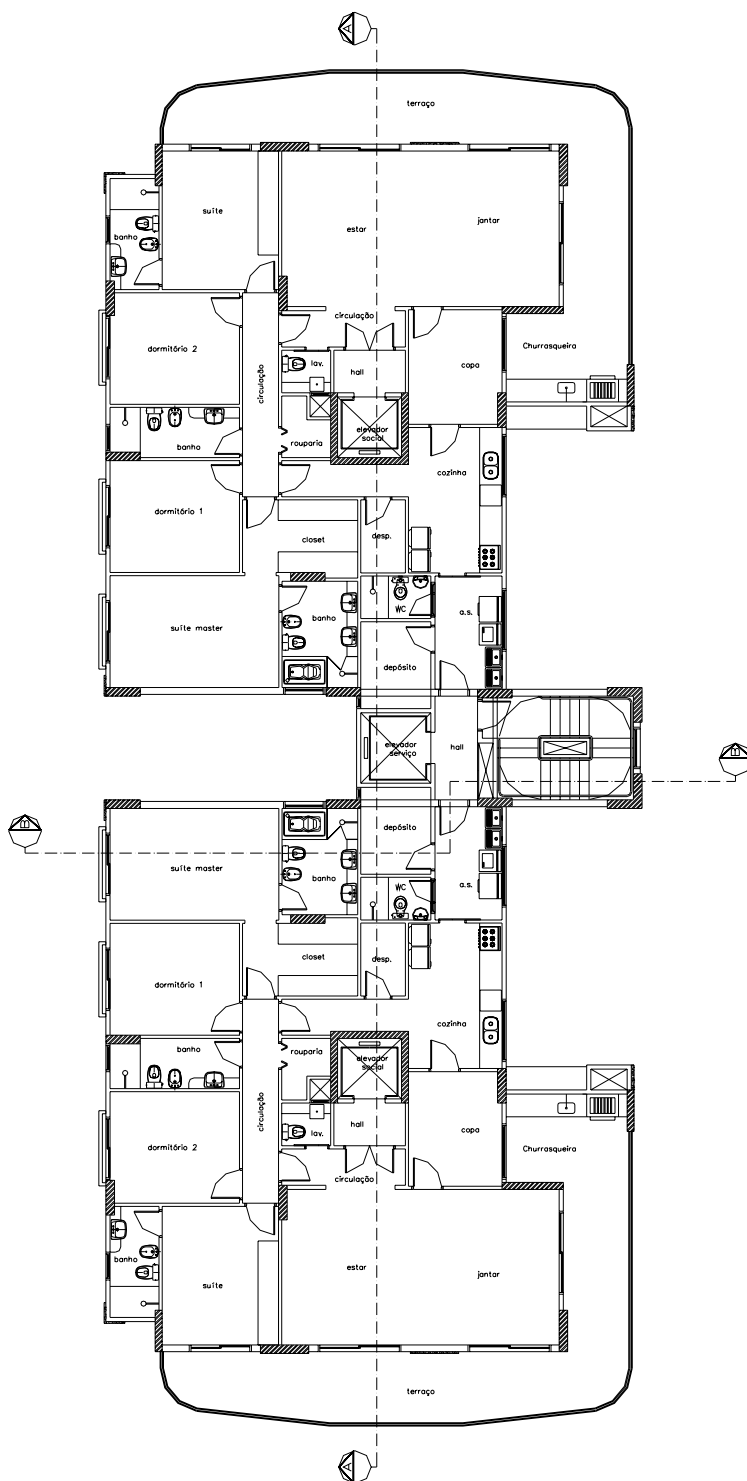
16 Planta baixa do pavimento tipo do edifício em estudo
